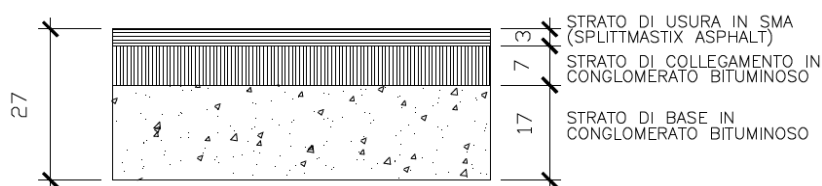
COMPOSIZIONE DELLA SOVRASTRUTTURA STRADALE
